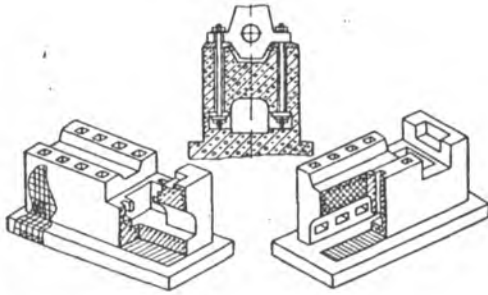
Железобетонный тоннельный фундамент для крупной стационарной машины
